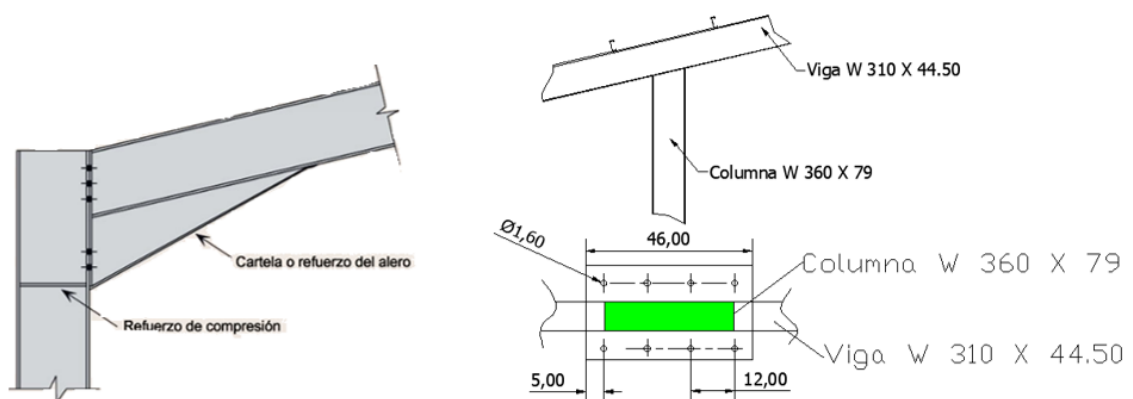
Conexión viga – columna. Fuente: Autores 2022
